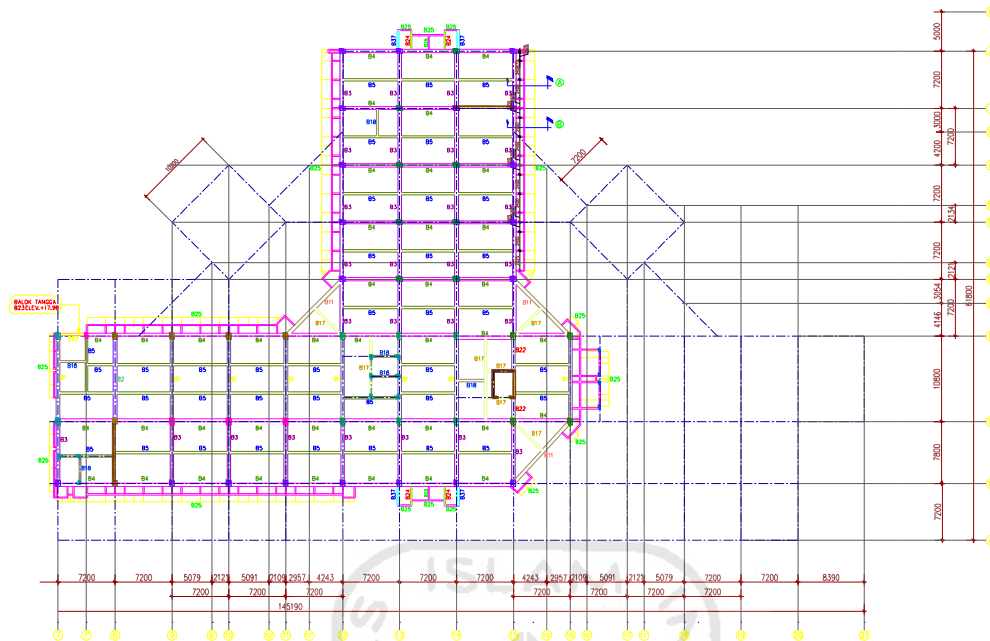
4 Denah Balok Gedung RSA UII Lantai 4
